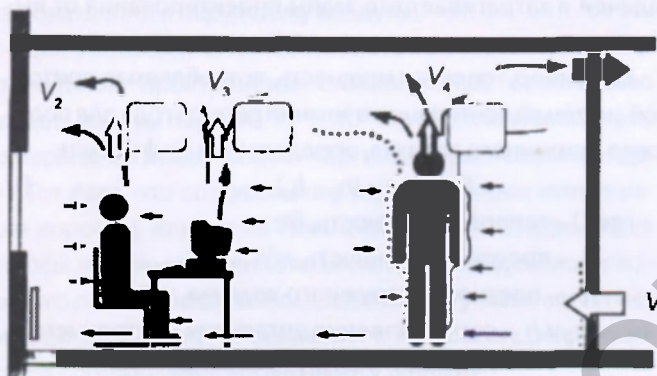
Схема движения потоков воздуха вытесняющей вентиляции в непроизводственных помещениях
